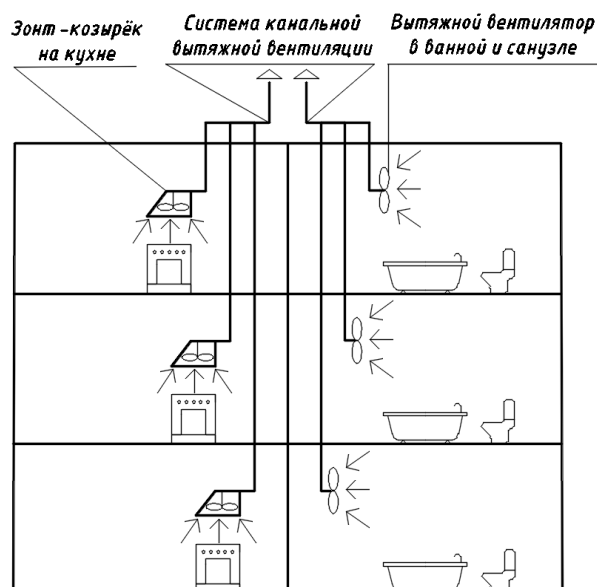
Схема вытяжной естественной канальной вентиляции в 3-х этажном многоквартирном доме с установленными нагнетателями.
